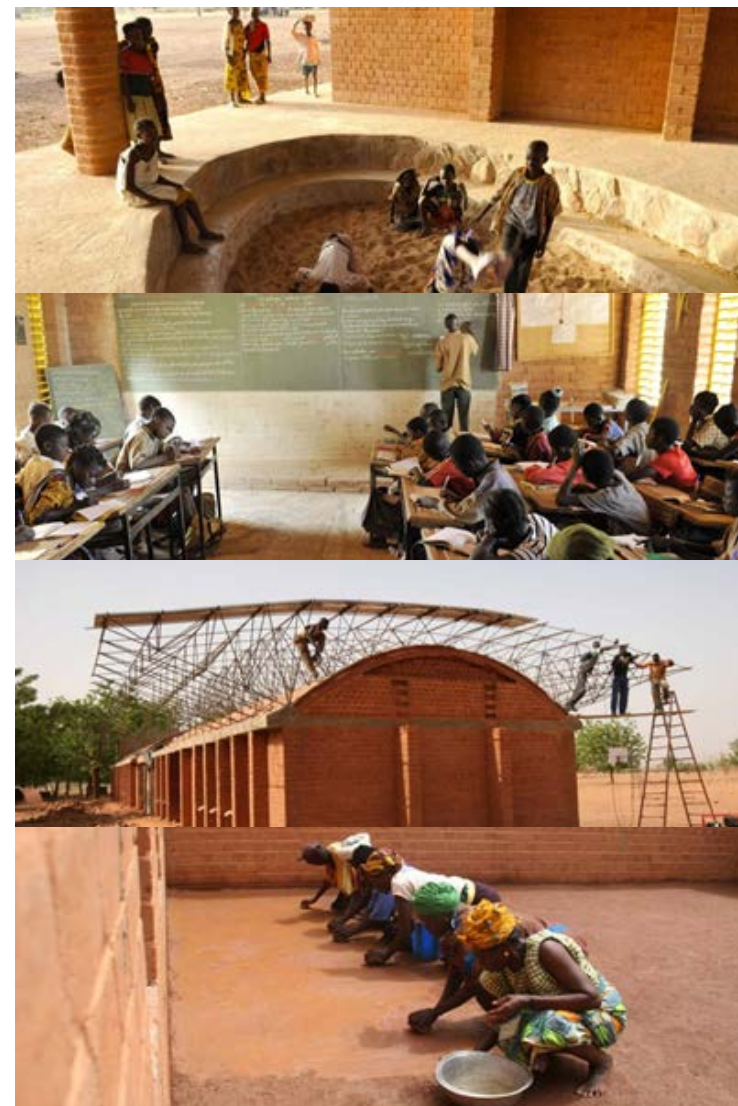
Montagem de fotos da Escola Gando, uso e construção
